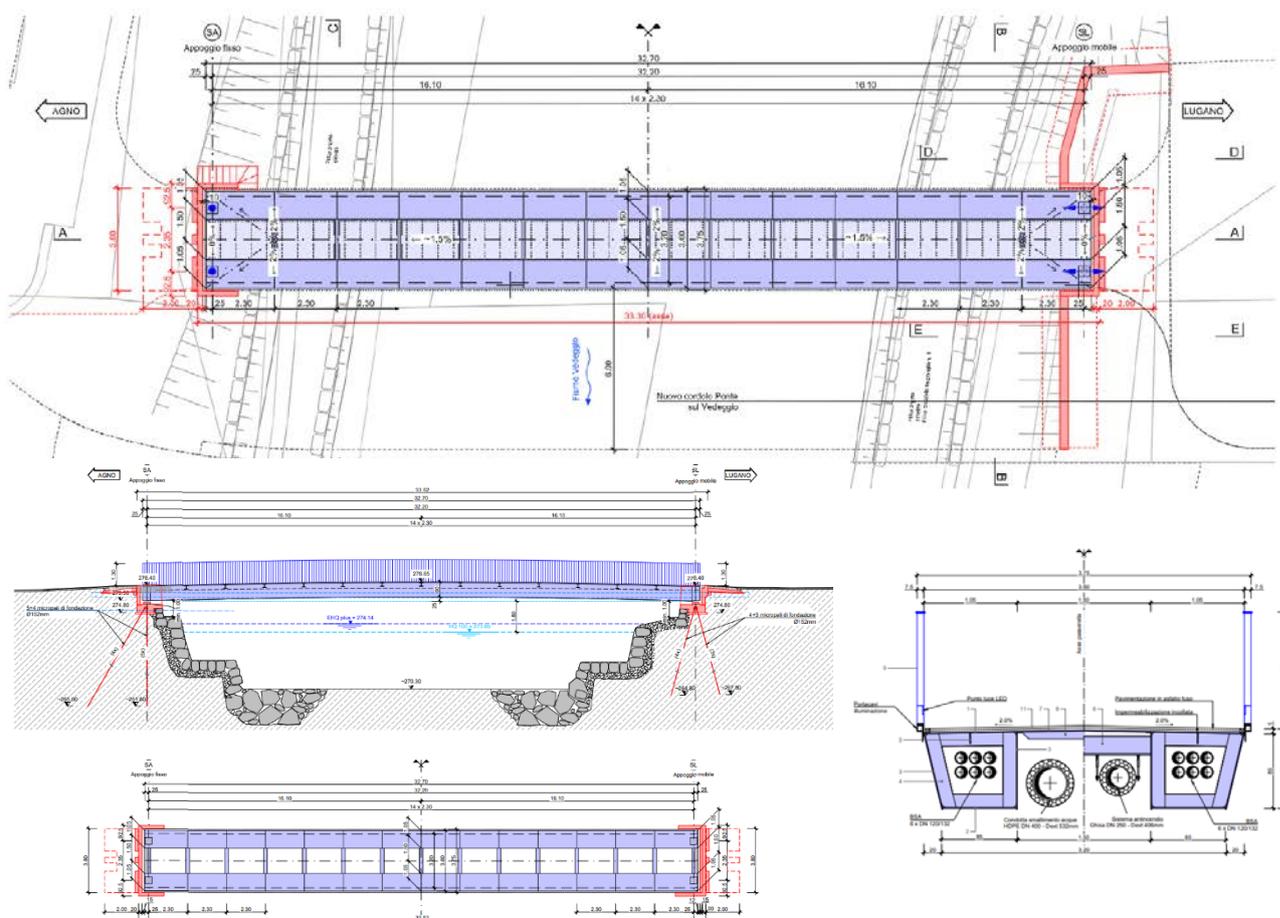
Passerella sul Vedeggio: planimetria, profilo e sezione
